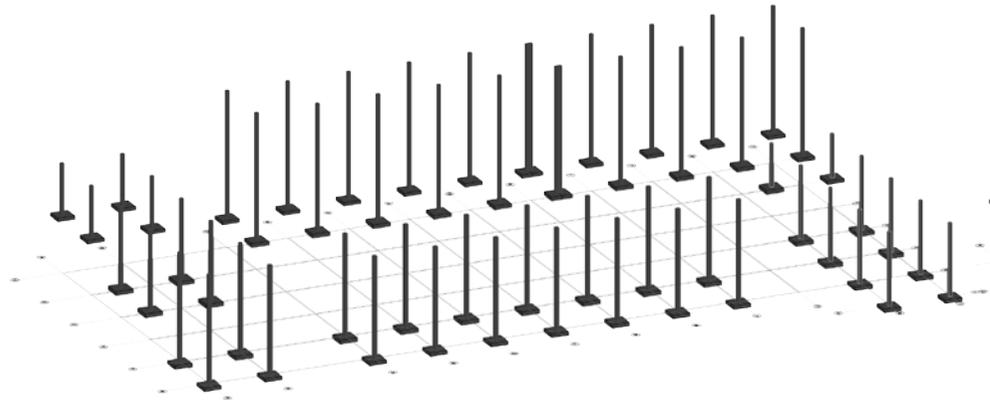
A partir de una malla estructural de 7,50 x 7,00, se establecen las zapatas de cimentación en conjunto con las columnas de hormigón armado de 0,40 x 0,40.
